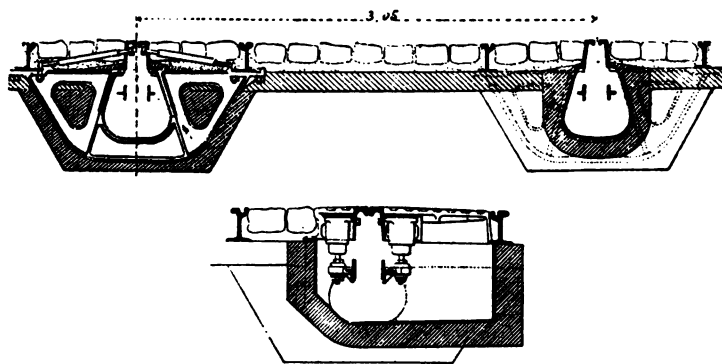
Caniveau système Connett. — Coupe en voie courante et coupe sur regard.
